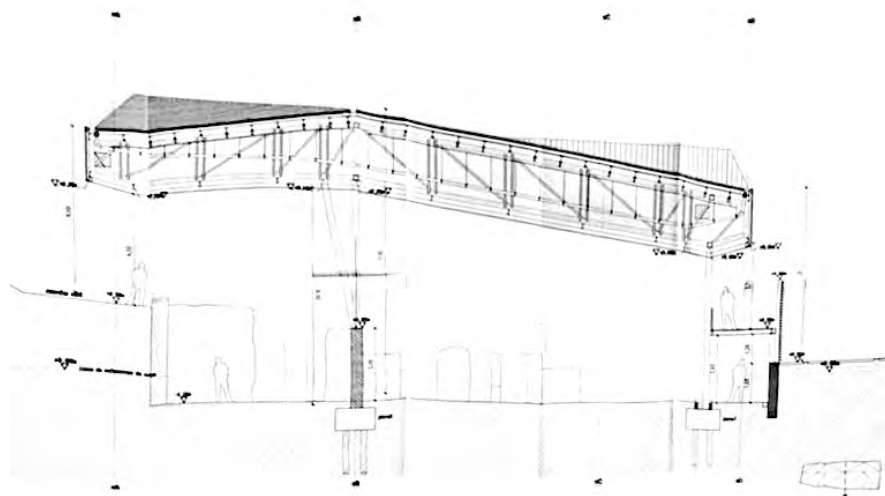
Plano de sección transversal del Proyecto de cubierta del Cerro del Molinete. (Cánovas y Maruri, 2009)
